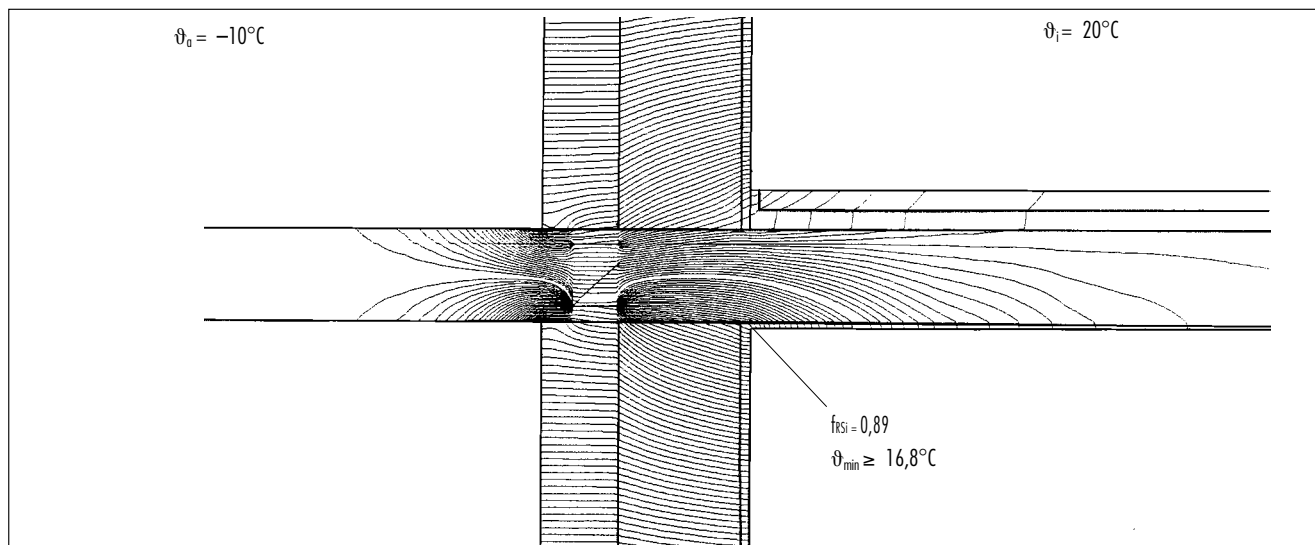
Detail spojení s Schöck Isokorb® u dvouvrstvého zdiva
